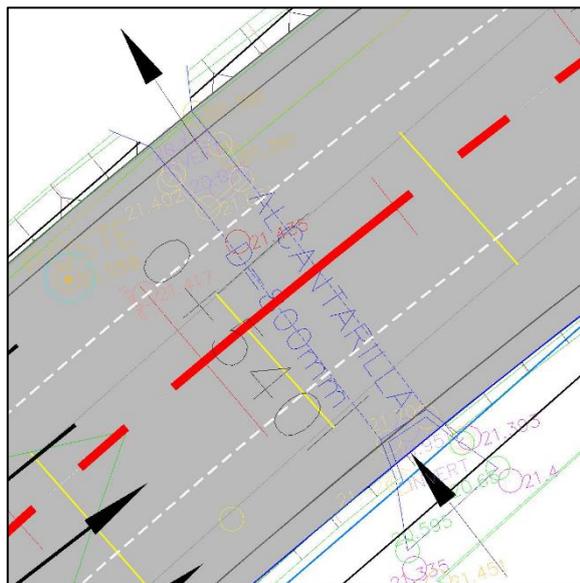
Vista en planta de Alcantarilla en abscisa 0+542.
